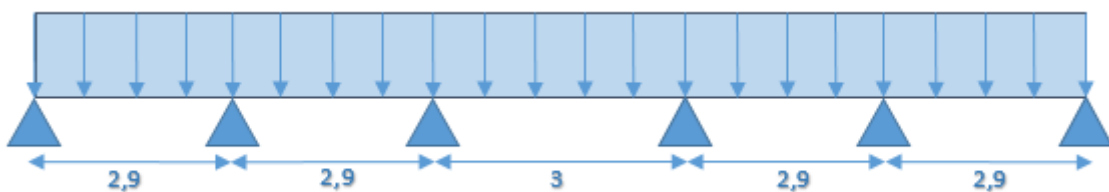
schéma statique de la poutrelle à 5 travées.
